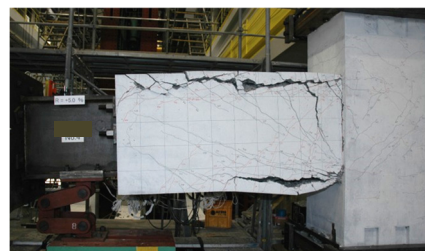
付着割裂ひび割れの状況（ $R=+5.0\%$ 時）
